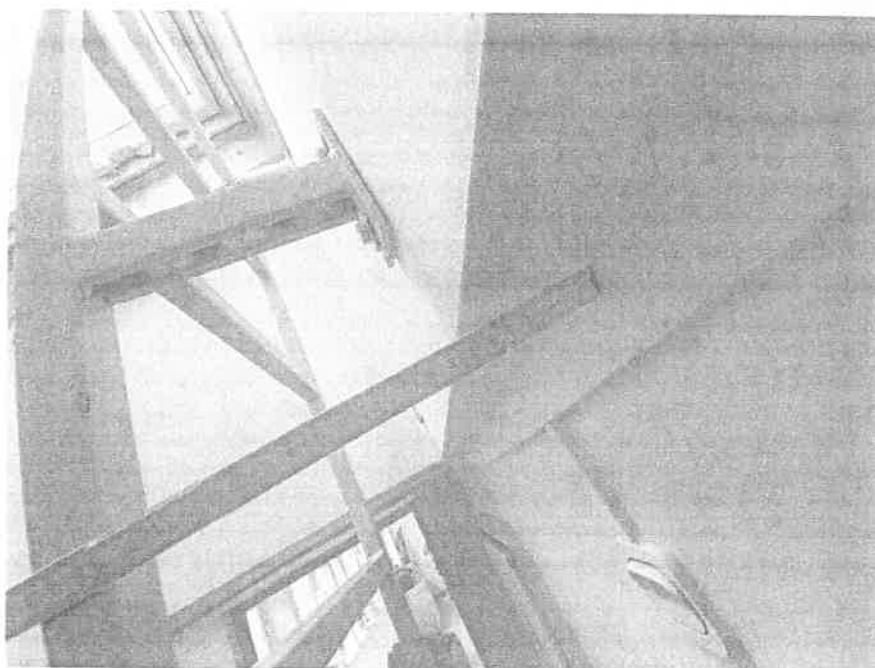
Widok ogólny pokrycia dachowego (z papy asfaltowej).
